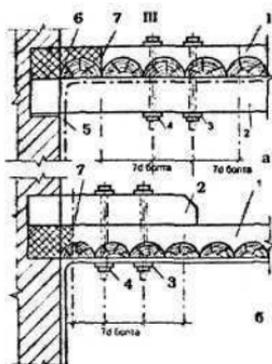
Ремонт деревянных перекрытий (продолжение):
